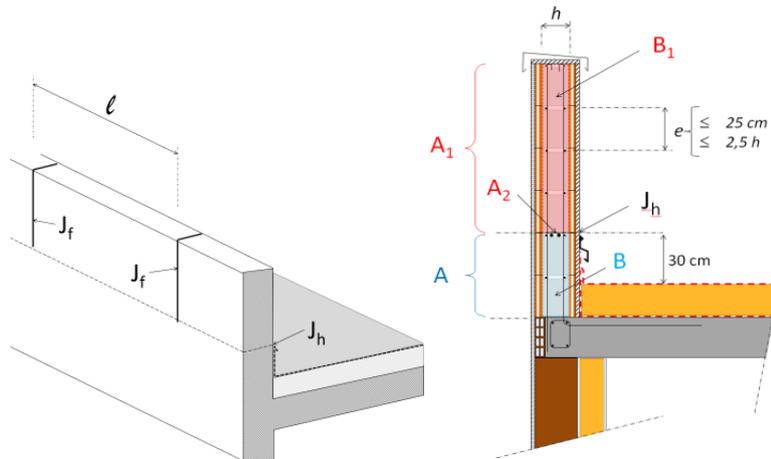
section totale d'armatures horizontales des acrotères hauts
